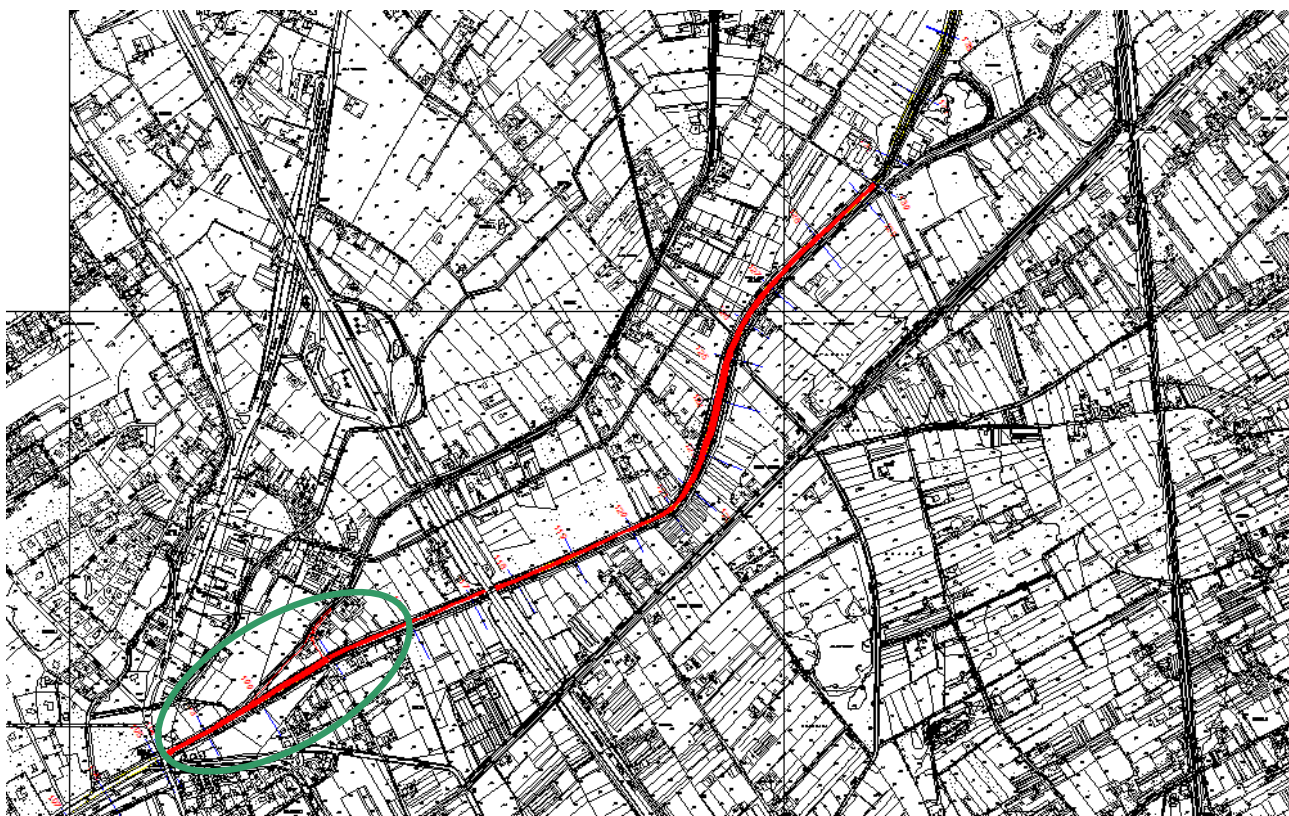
Planimetria intervento (lotto attuale cerchiato in verde)
